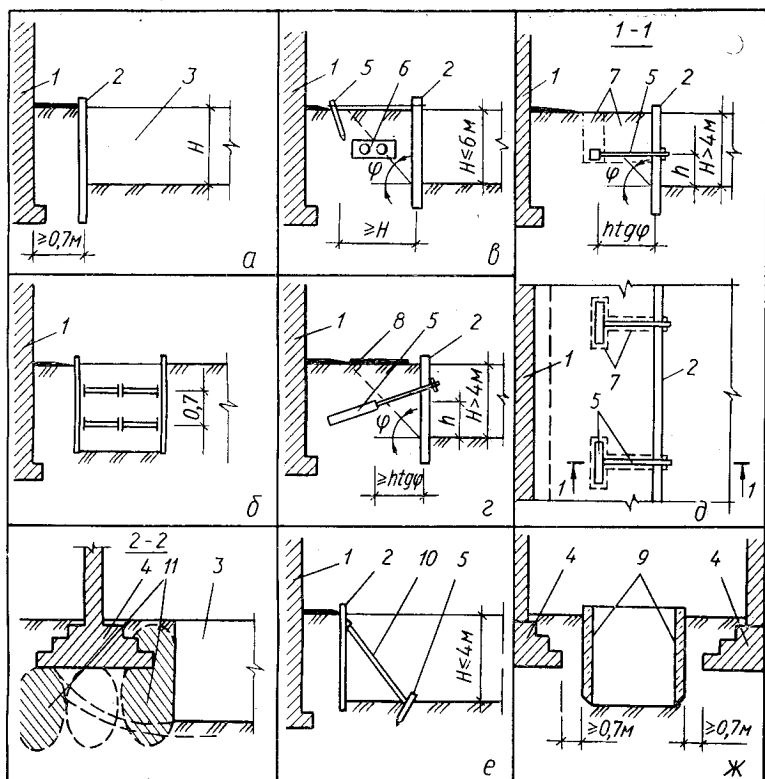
Виды крепления стенок выемок в стесненных условиях:
